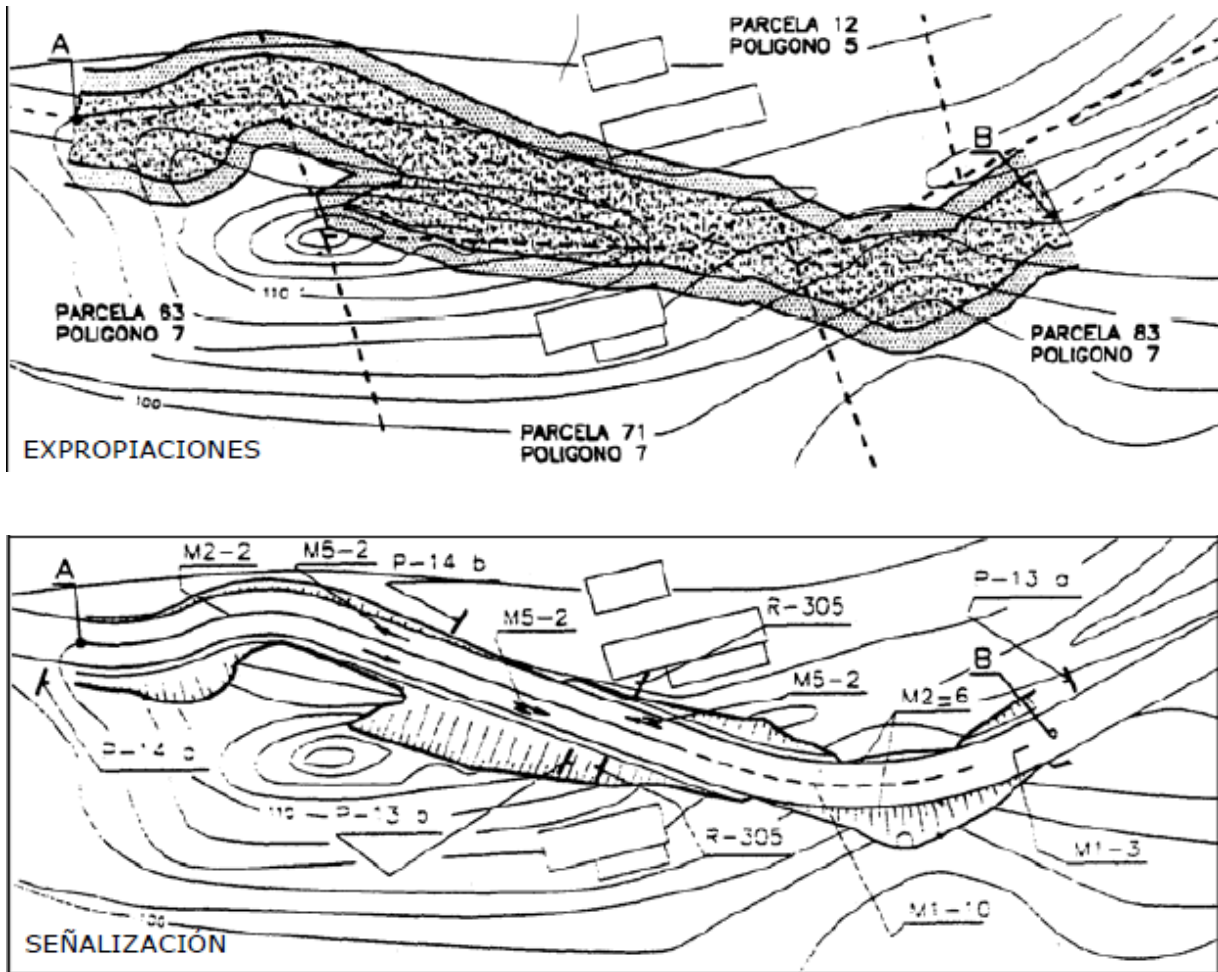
Diversas plantas empleadas en carreteras. (Bañón; 2000: sección
